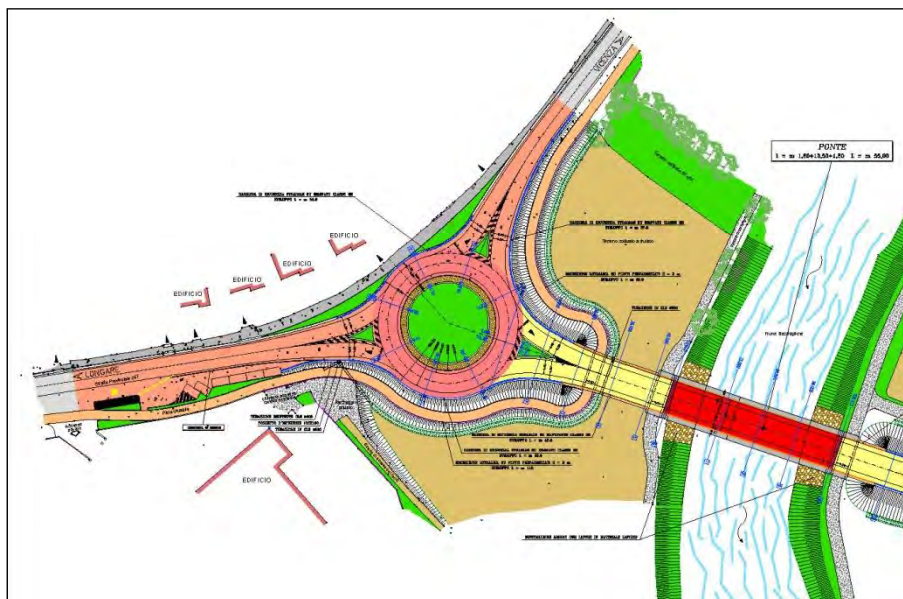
Ingrandimento planimetria di progetto variante giugno 2008: vista sud
